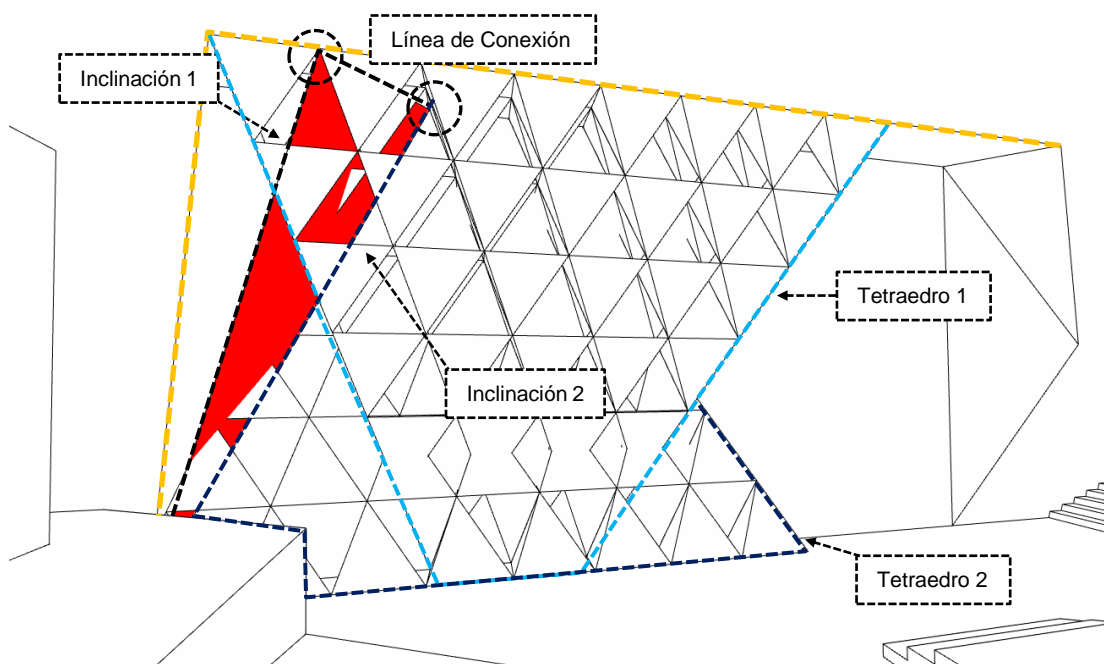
Plano Inclinado, Margen Izquierdo, Parte 2
